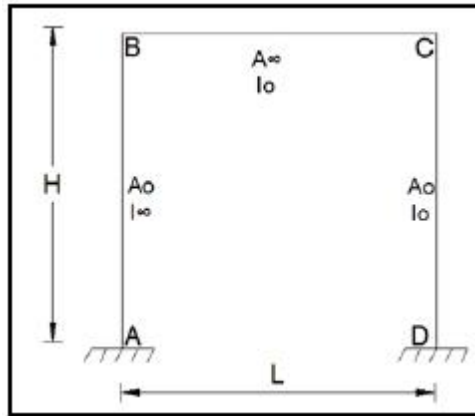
Pórtico de Ejemplo 10, con columna transversalmente rígida y viga axialmente rígida.
